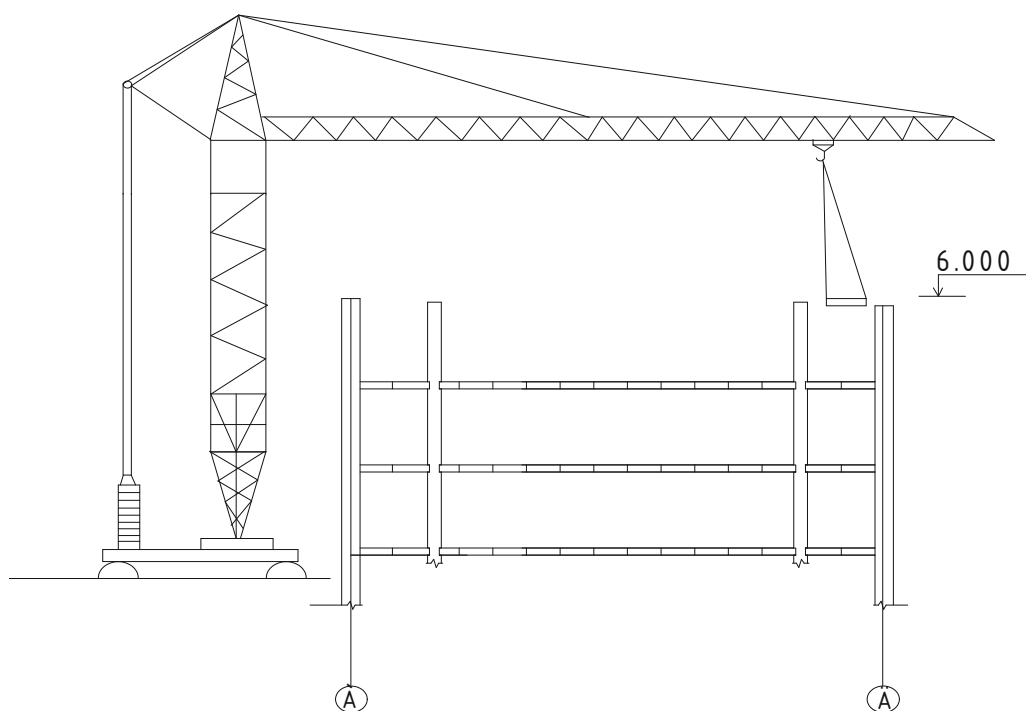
Разрез схемы монтажа плит перекрытия
